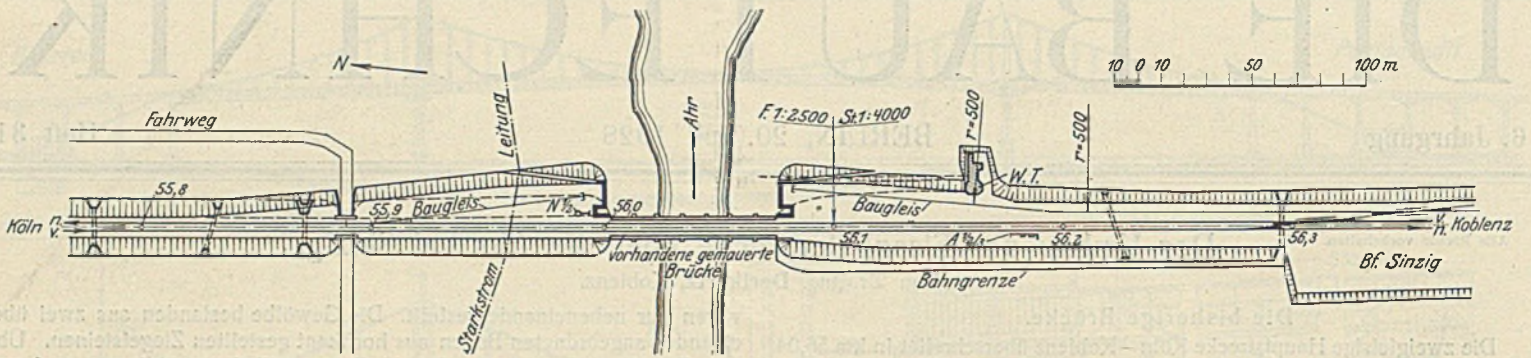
I. Bauabschnitt: Herstellung der Widerlager für die vorläufige Brücke und des Bahnkörpers.
